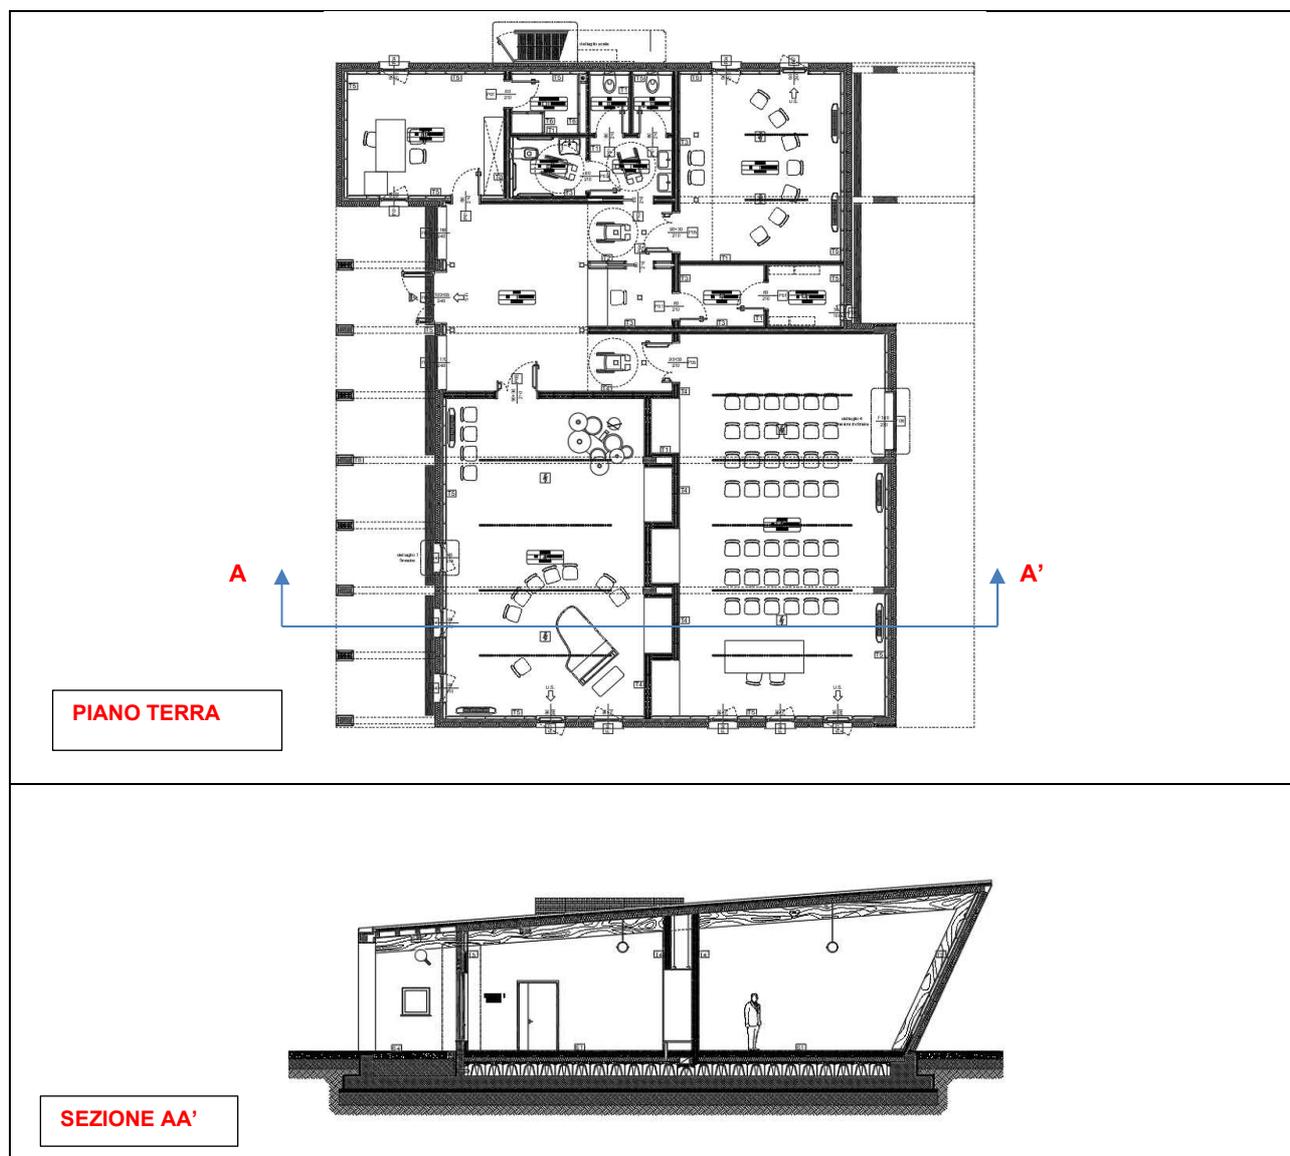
Stralcio planimetrico piano terra e sezione AA'
